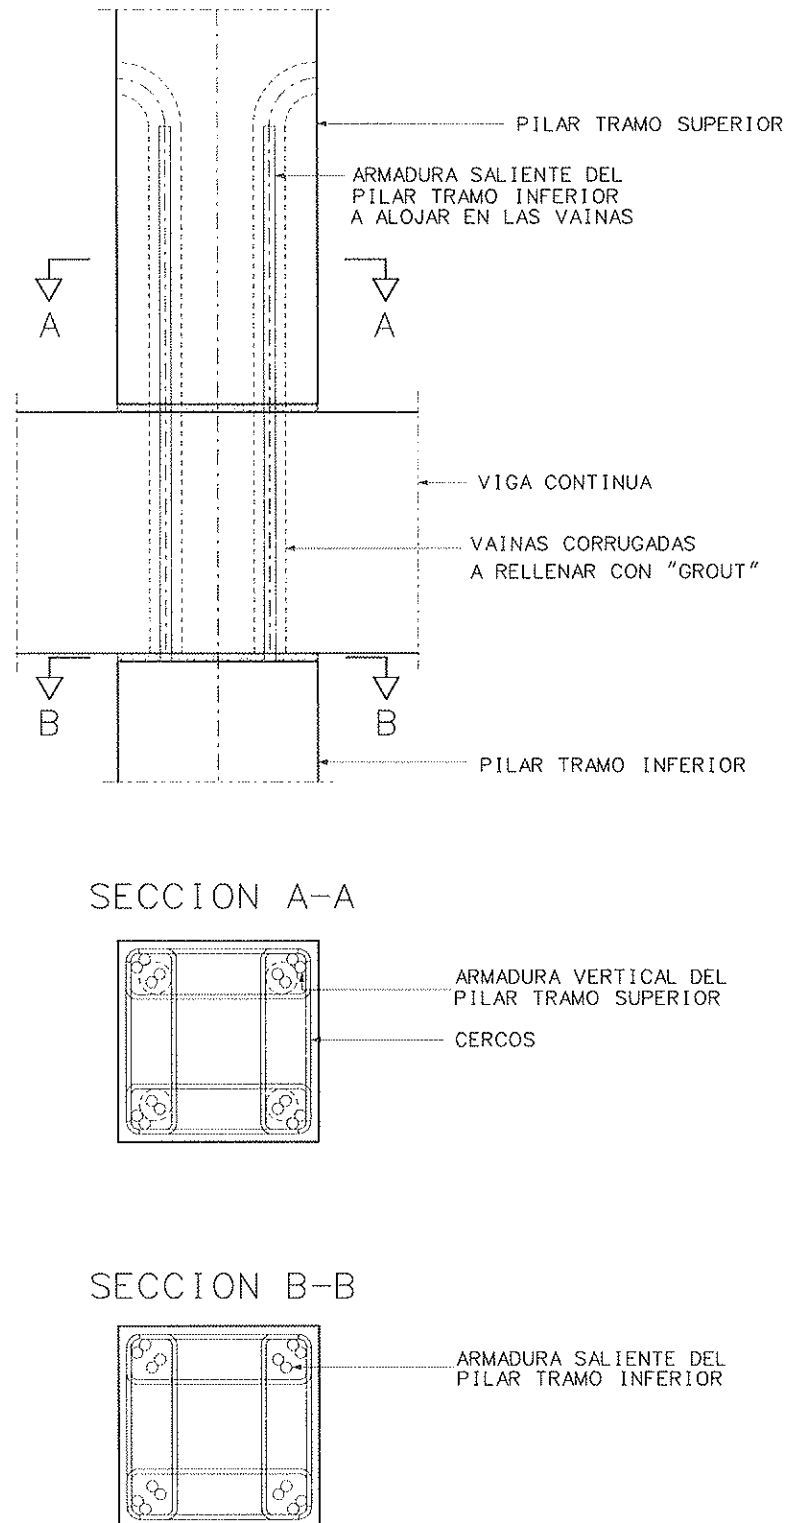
Nudo pilar-vigas con armadura vertical pasante.
